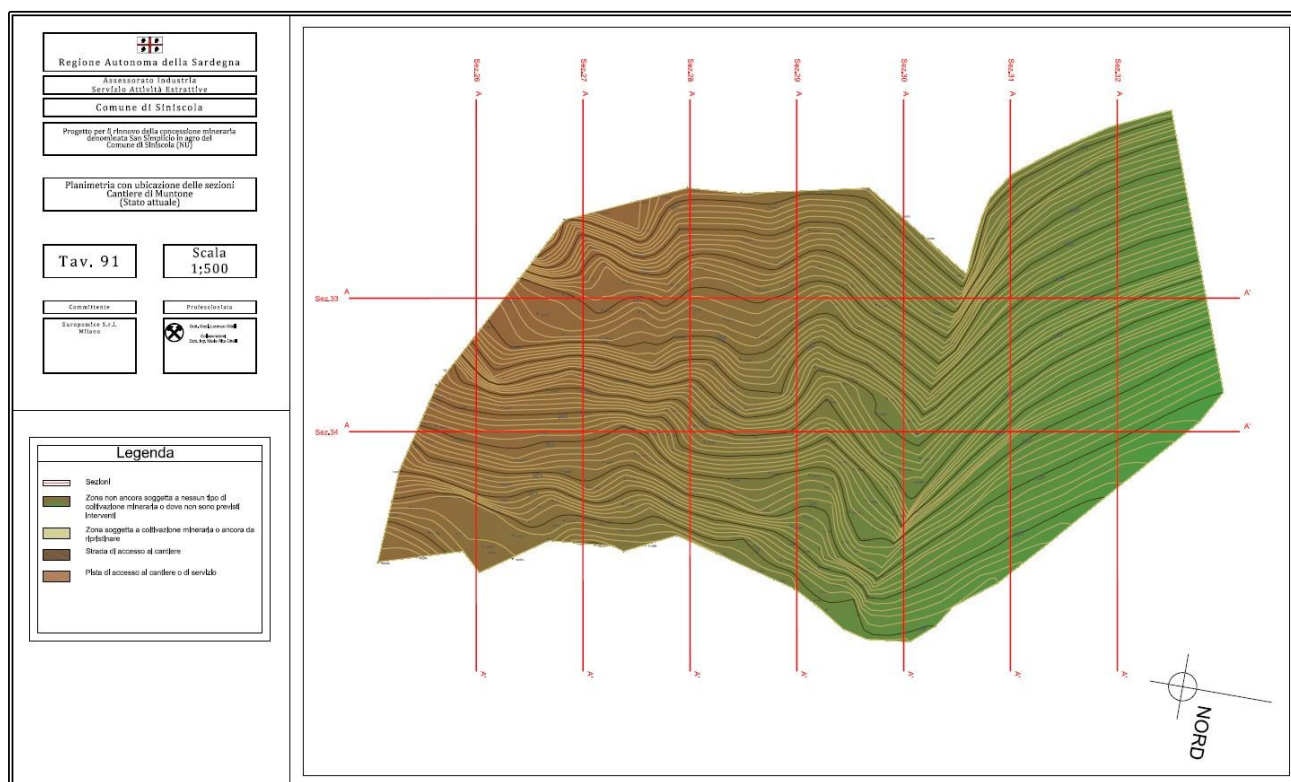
Planimetria dell'area del cantiere di Muntone così come allo stato attuale.
